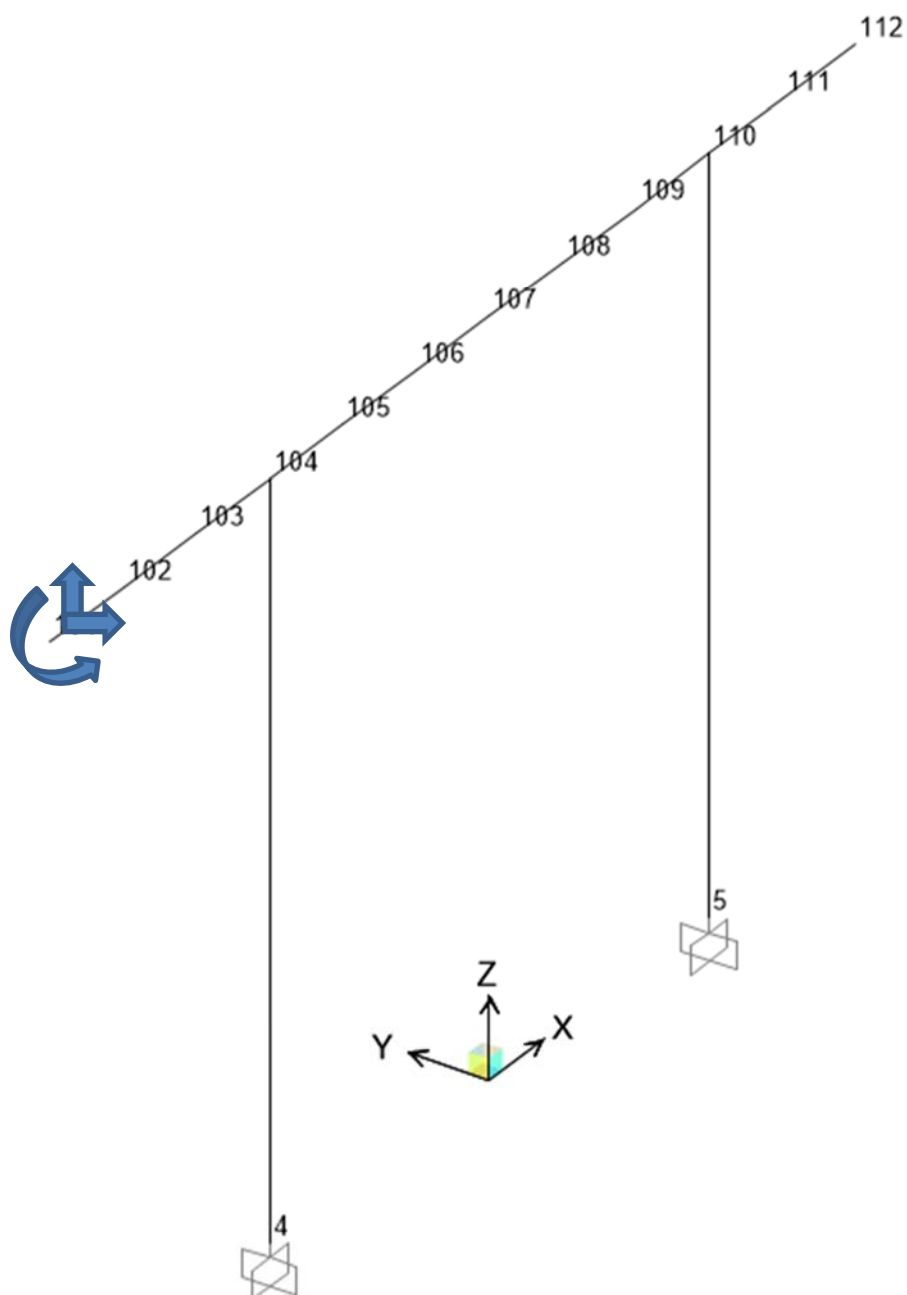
Modello piano pilastri terminali e trave longitudinale soprastante – sezione di transizione.
